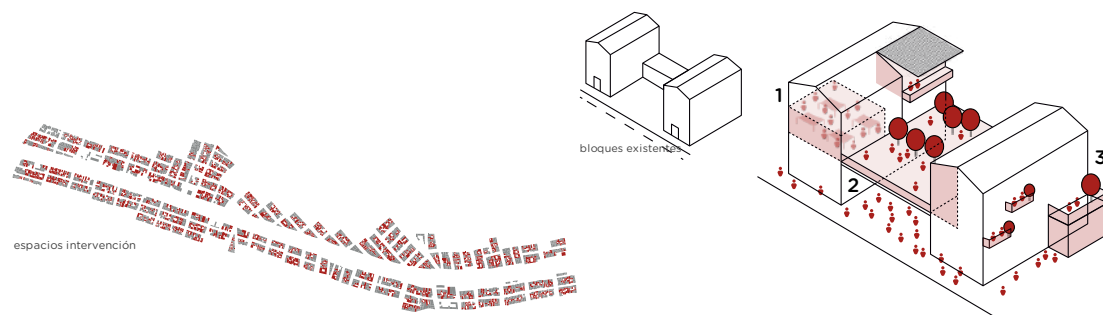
Estrategias Arquitectónicas | Patio Elevado Adaptativo
